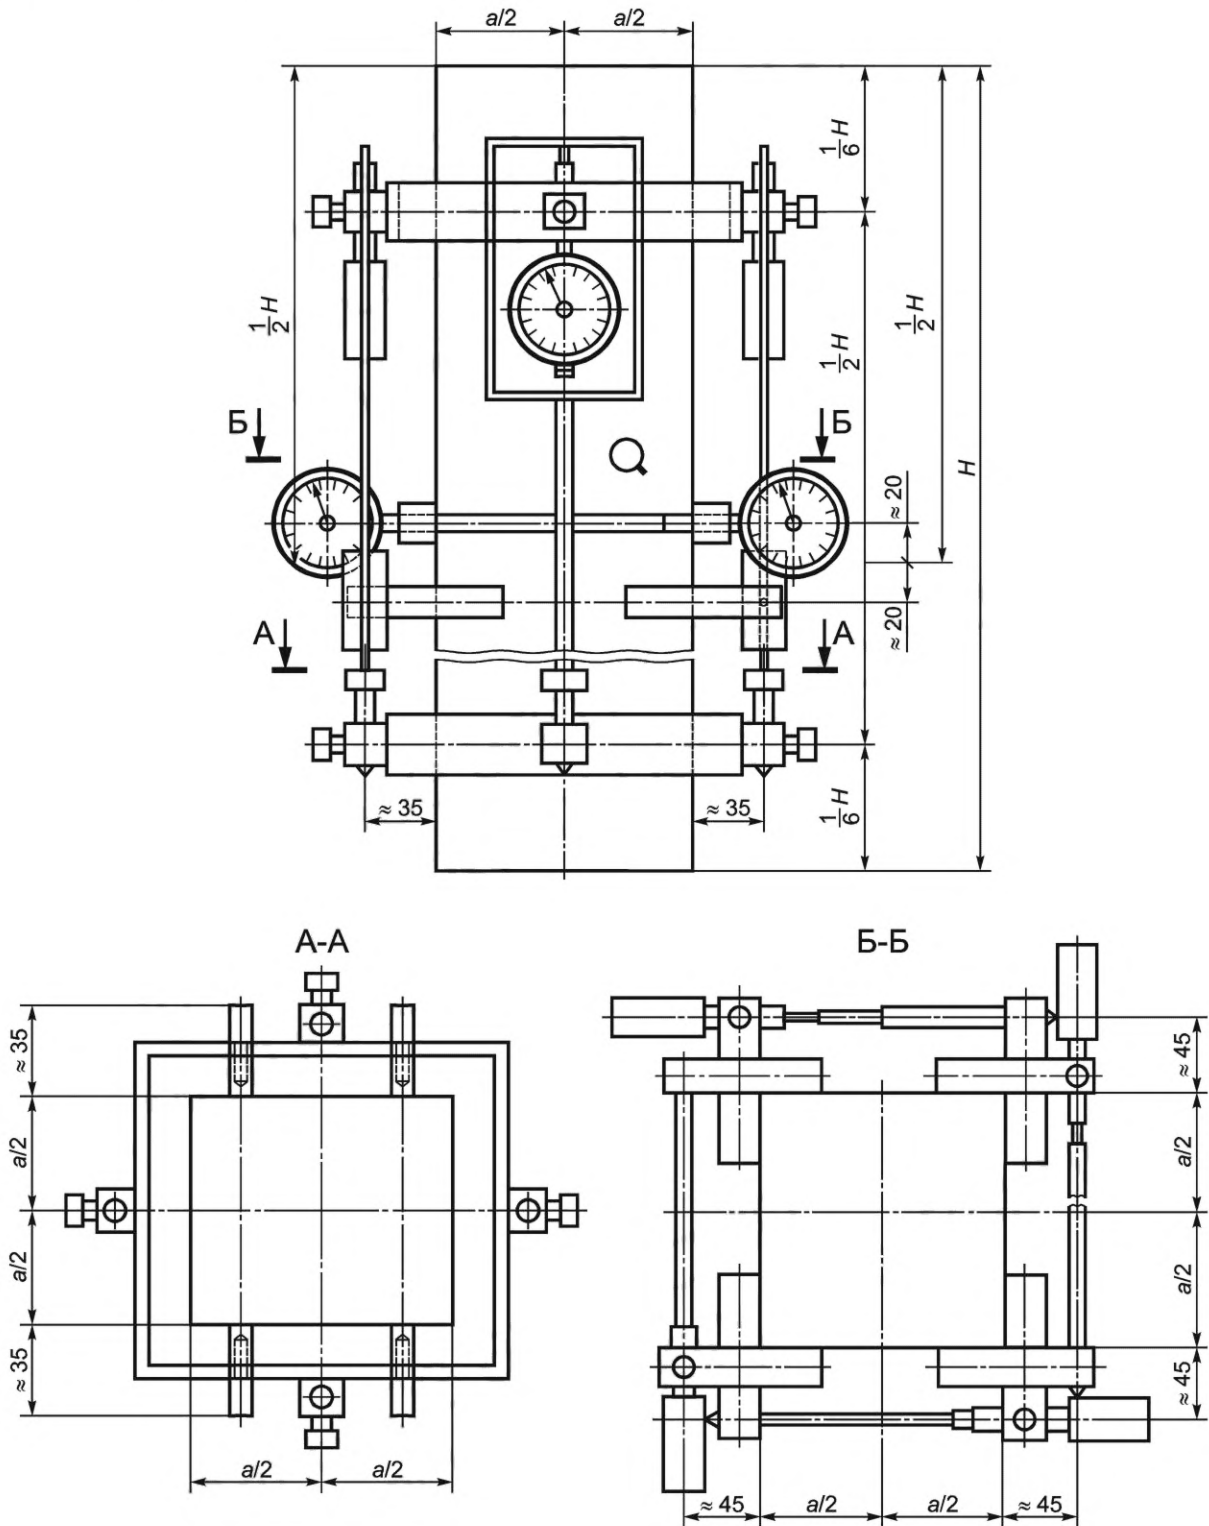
Схема установки приспособлений для крепления индикаторов при измерении продольных и поперечных деформаций образца
